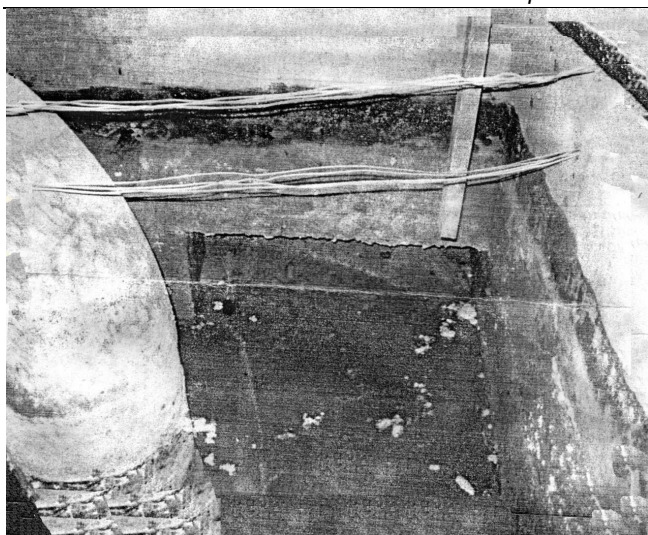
Участок стены, на котором образовался провал грунта основания фундамента и вывалился фундаментный блок
